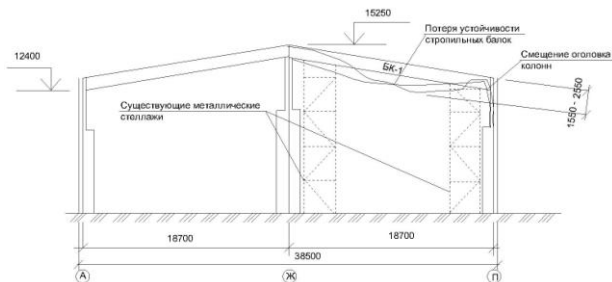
Схема обрушения стропильных балок с опиранием их на существующие стеллажи / The scheme of collapse of rafter beams with their support on existing racks
